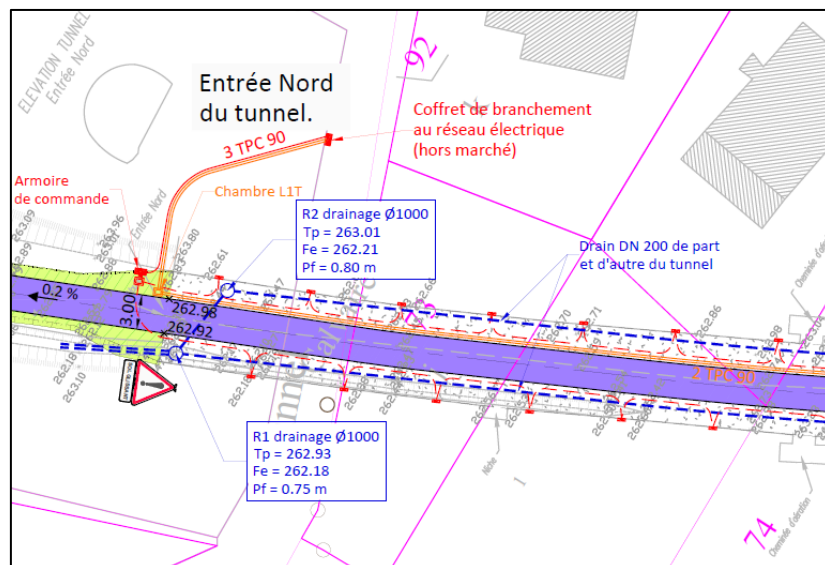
Vue en plan - travaux VRD au sein du tunnel
